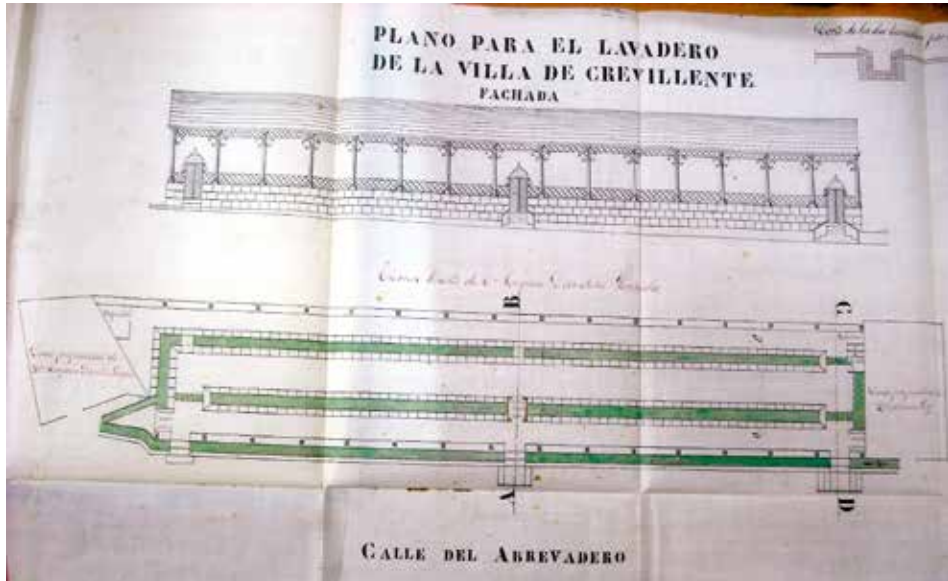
Planta y alzado del proyecto del Lavadero de 1884 firmado por José Guardiola Picó.
